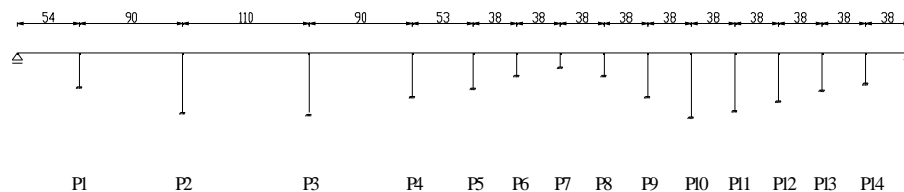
Esquema estrutural da ponte (alçado).
